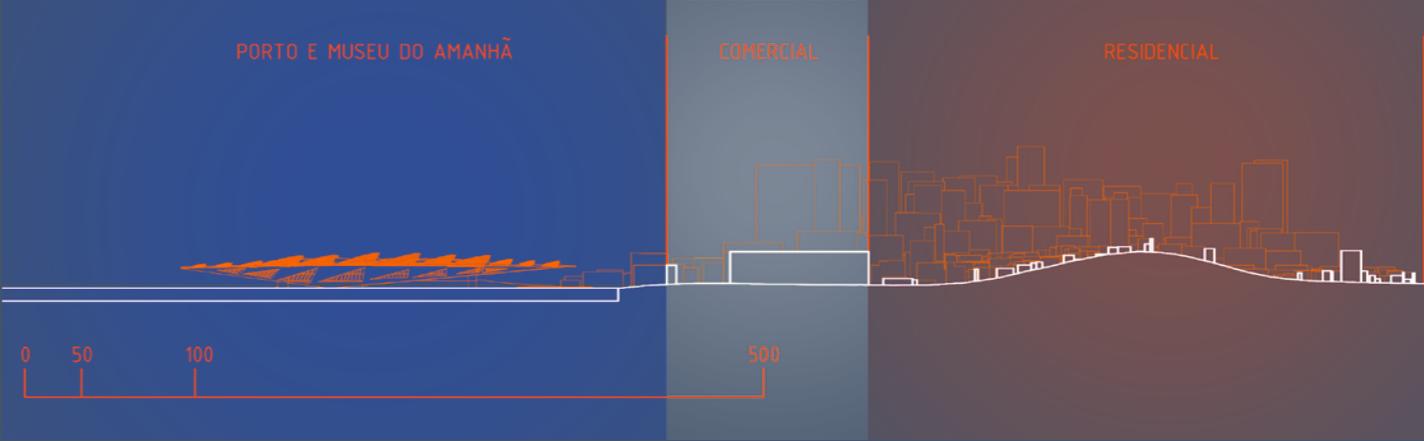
Corte longitudinal para Sul. Fonte: Autoria própria.
